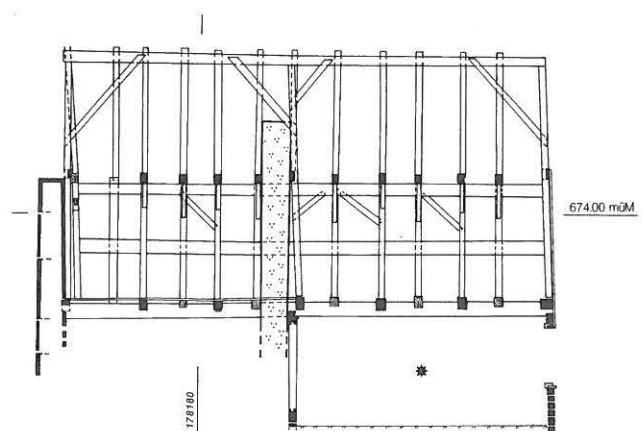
Längenbühl, Hattigen. Längsschnitt durch Dachstuhl. M. 1:150.
